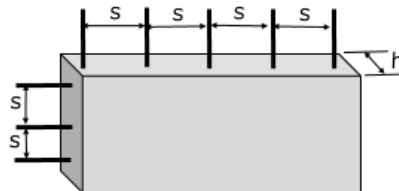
Espaciamiento máximo refuerzo horizontal y transversal. Fuente: Rochel (2010).
